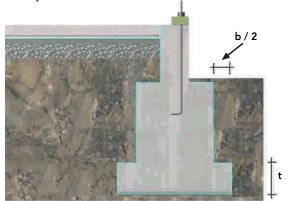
21: Ancho máximo de la zarpa sin armar.
